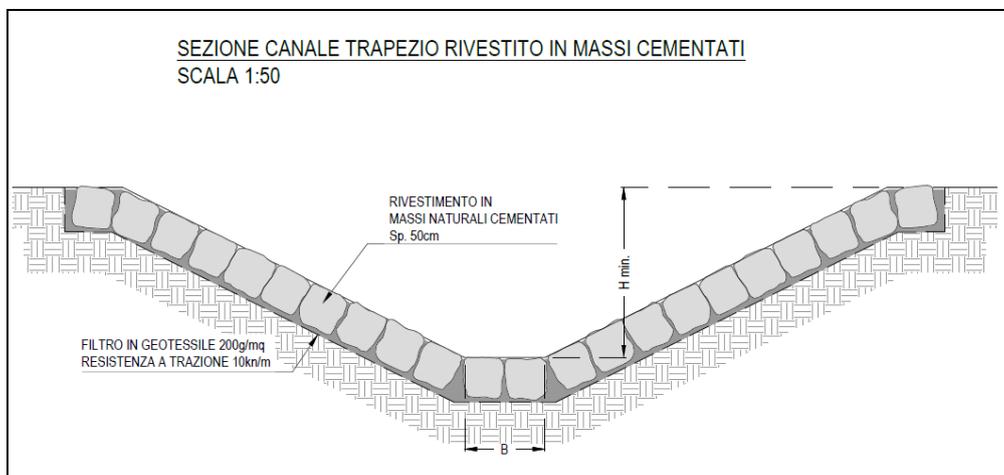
Inalveazione IN05 – sezione rivestita in massi cementati: Sezione tipologica
